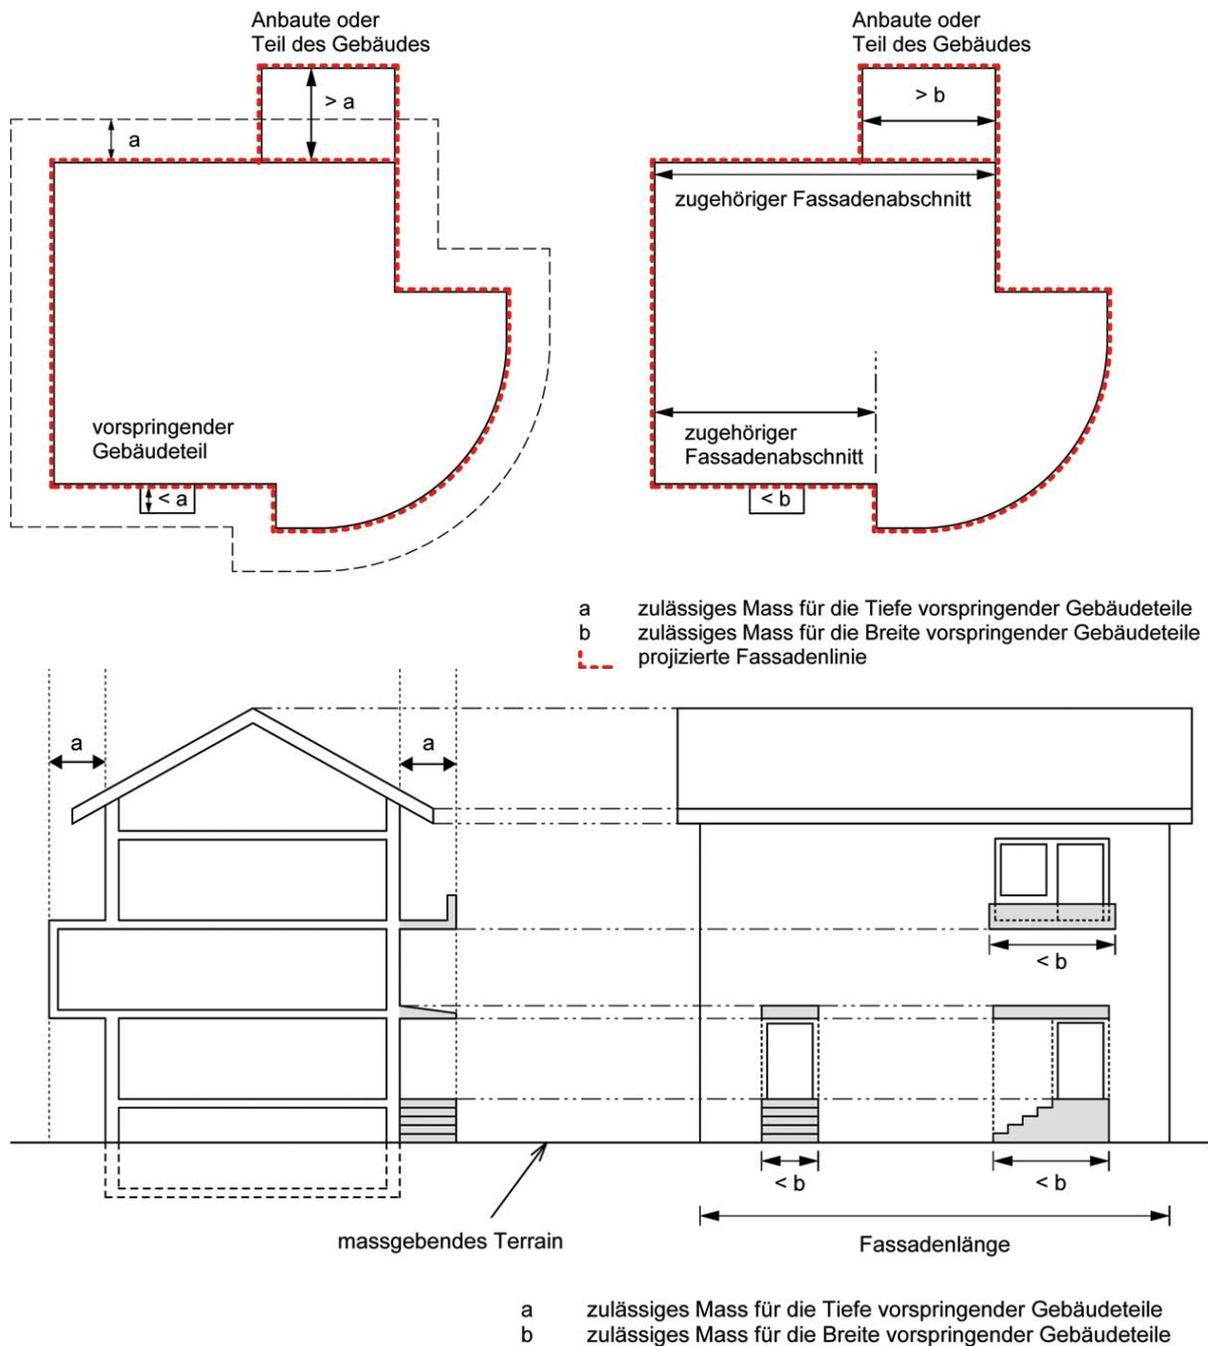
3.3 Fassadenflucht und Fassadenlinie
